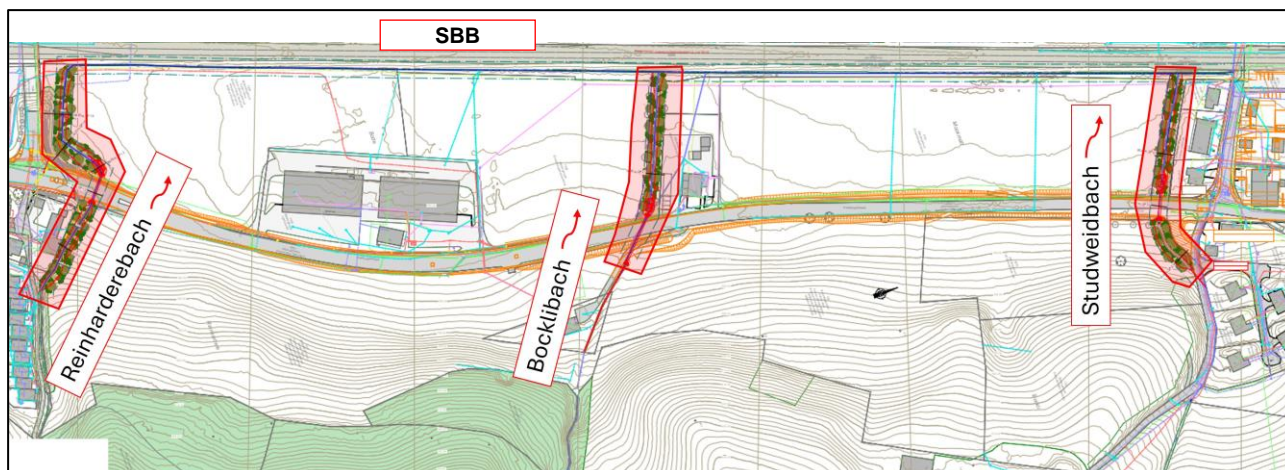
Situationsplan mit den drei Teilprojekten. Ein detaillierterer Plan findet sich in der Beilage.
